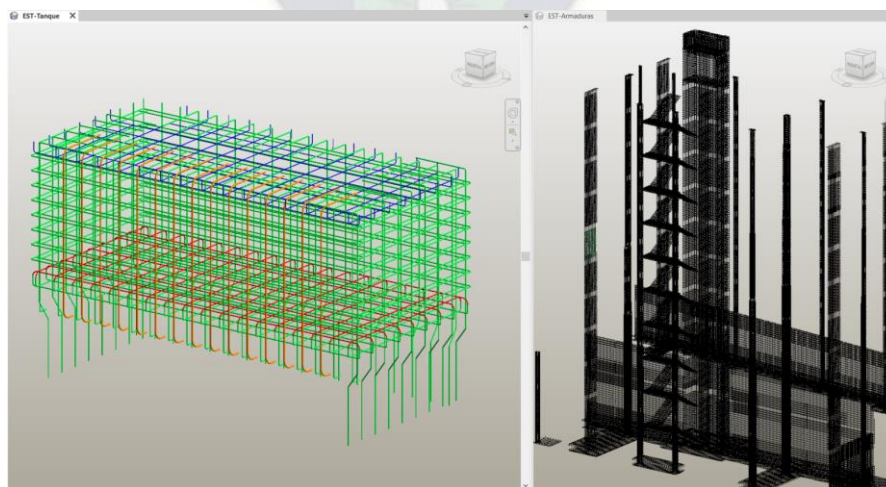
Armadura de elementos columna, muros, muros de contención, fundación y tanque elevado - Fuente: Elaboración propia
